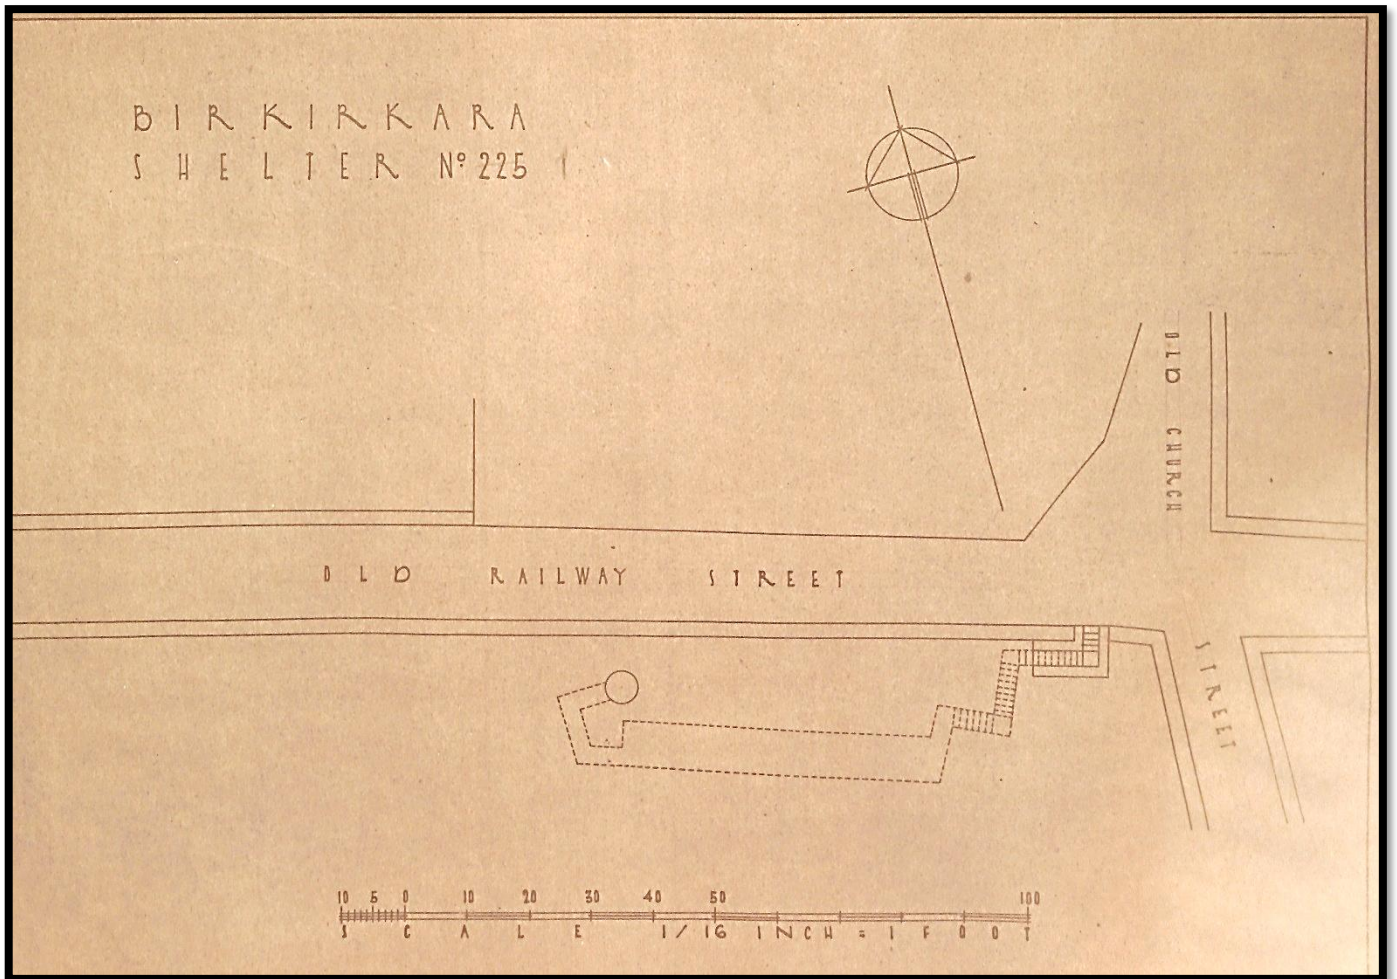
Planta do Abrigo nº 225 (1) "Old Railway Street – Old Church Street."
